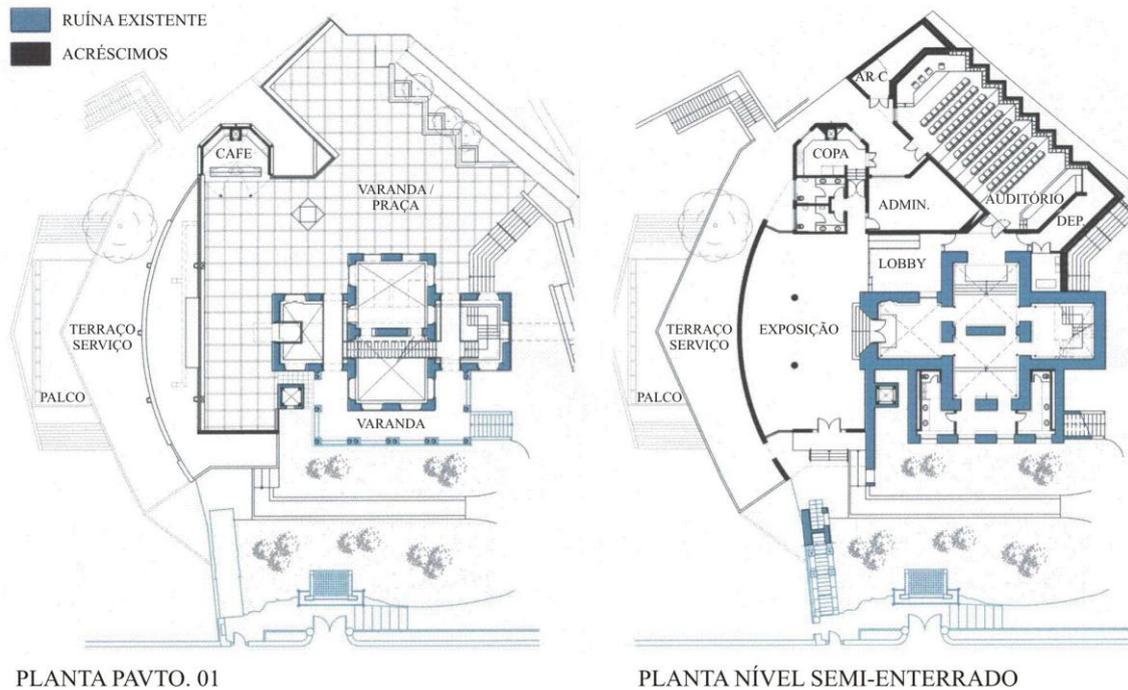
Plantas primeiro pavimento e nível semi-enterrado.
